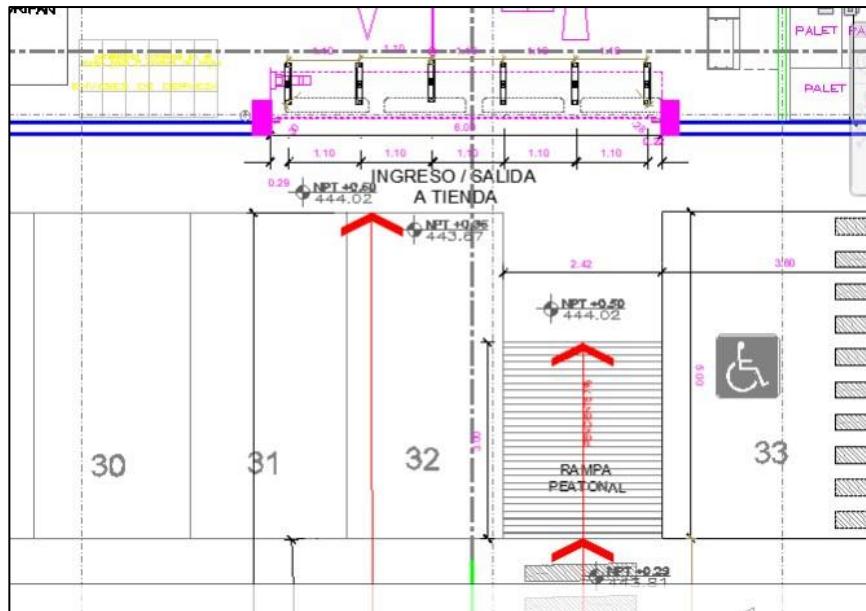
Plano Arquitectura– Ingreso a la Sala de Ventas.
